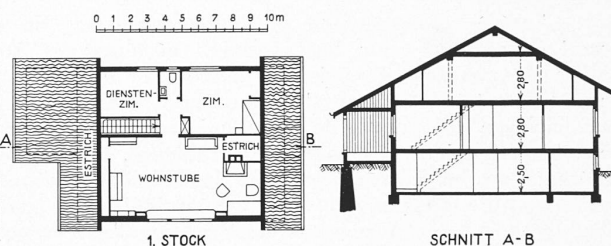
Das Eigenheim der Architekten W. Baur-Schill in der Geissmatt in Luzern. Grundrisse und Schnitt 1:400.
